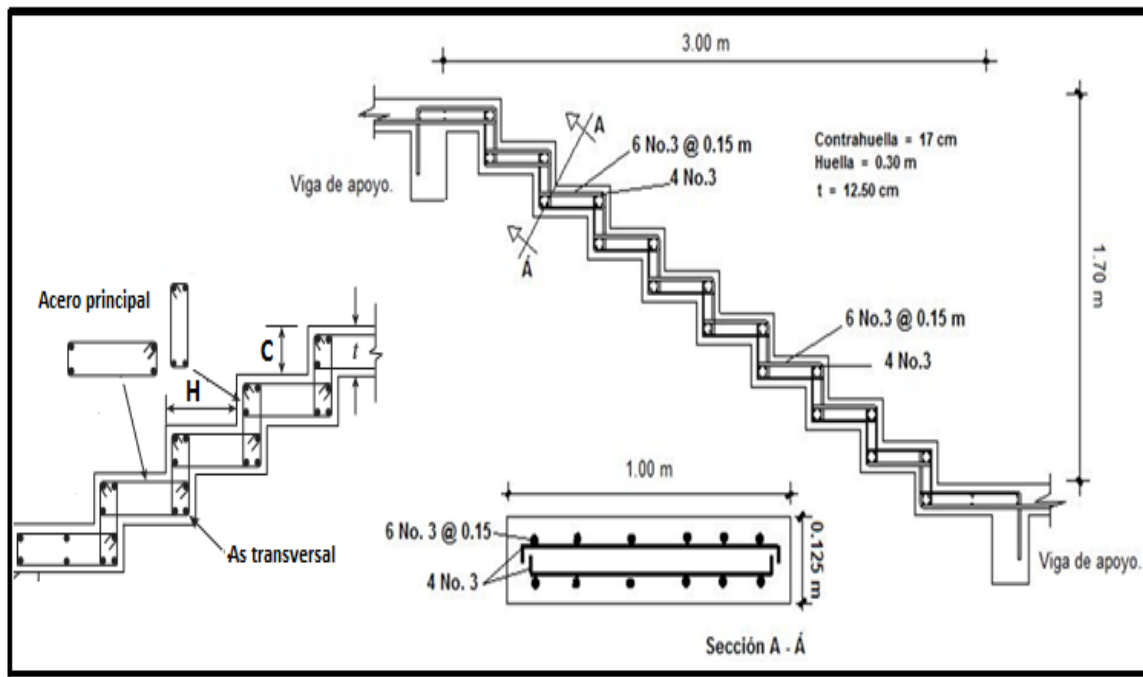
Esquema de armado de escaleras ortopoligonales apoyadas longitudinalmente.
